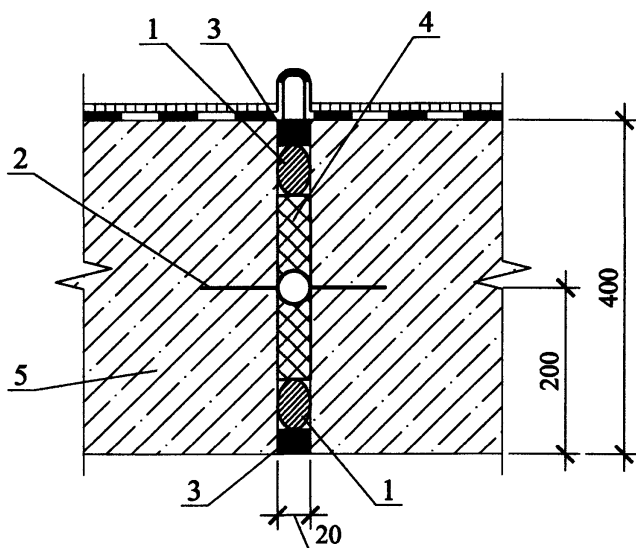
Герметизация усадочного шва в стене подвала при строительстве заглубленных и подземных сооружений
